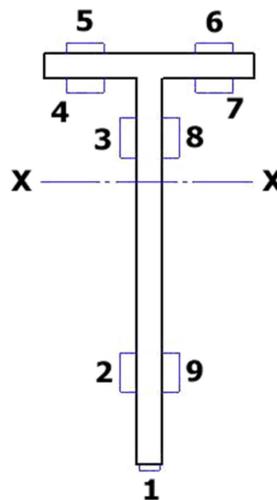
Disposición de las nueve galgas longitudinales de que dispone la viga.
